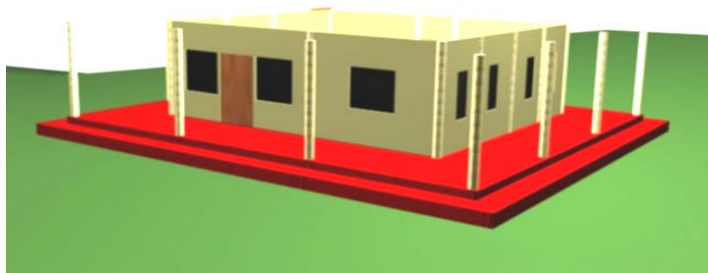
Sistema Construtivo. 5º passo : instalação das esquadrias e preparação da estrutura de telhado (Fonte: Maquete eletrônica de Janderson de Oliveira).
